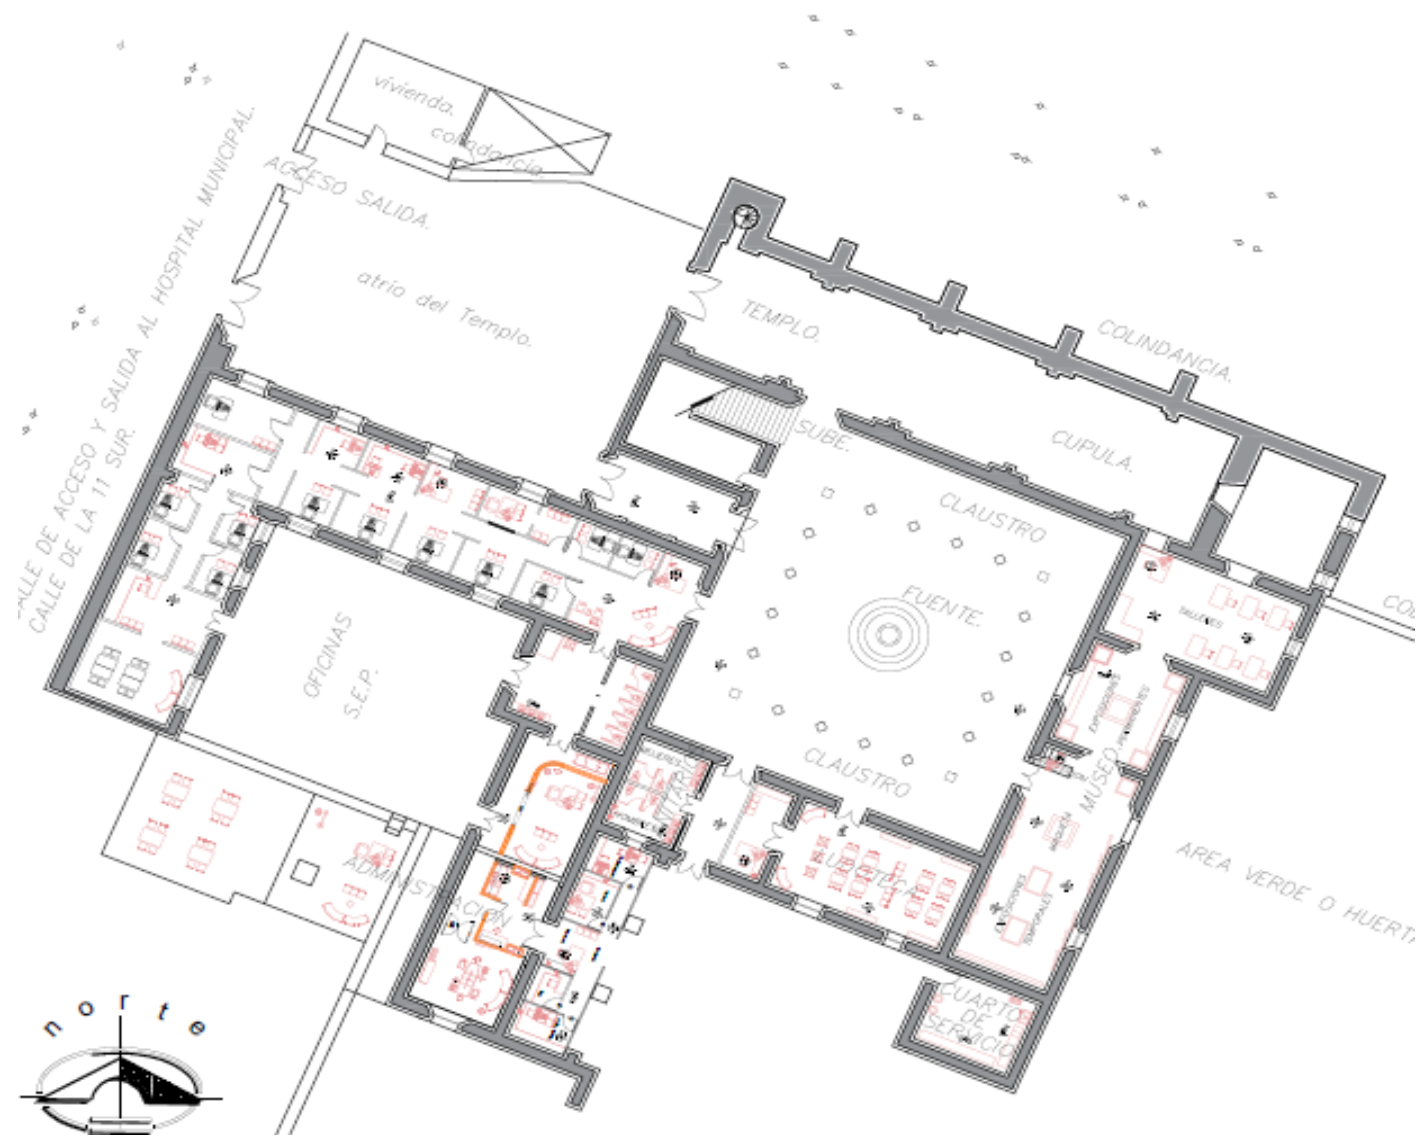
Planta arquitectónica planta baja de propuesta de distribución de espacios para propuesta de nuevo uso en Ex Hospital de San Juan de Dios.
